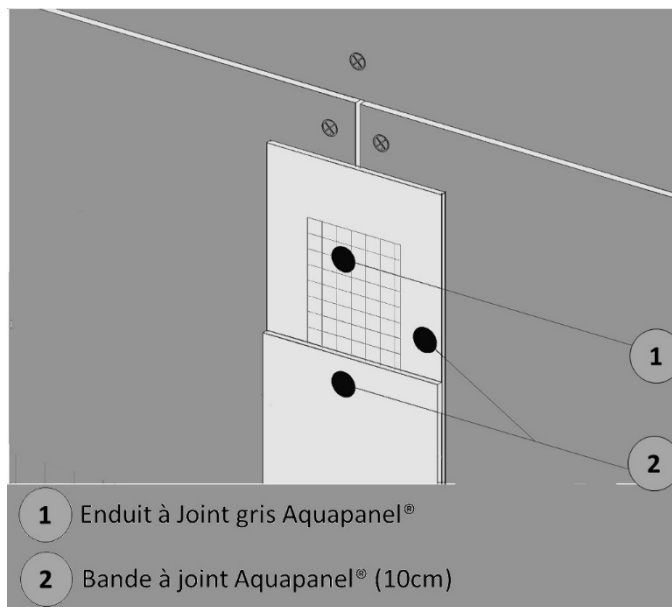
is - Jointolement - Mise en œuvre des joints entre plaques – détails
